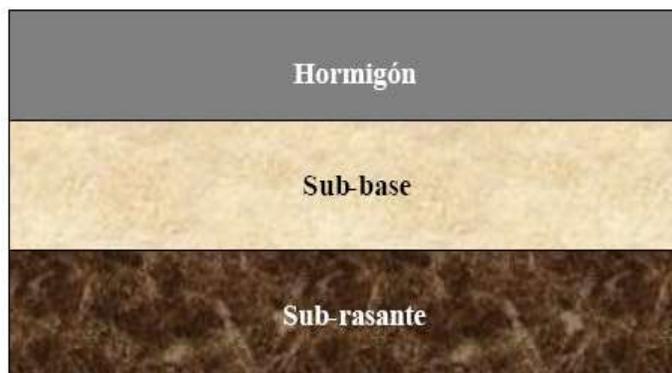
Componentes estructurales de los pavimentos asfálticos y de Concreto hidráulico.
